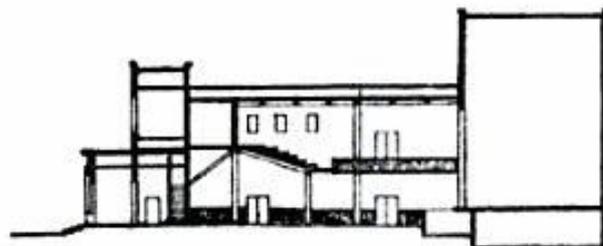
Sección norte-sur del “Teatro de Chen Kwang”
